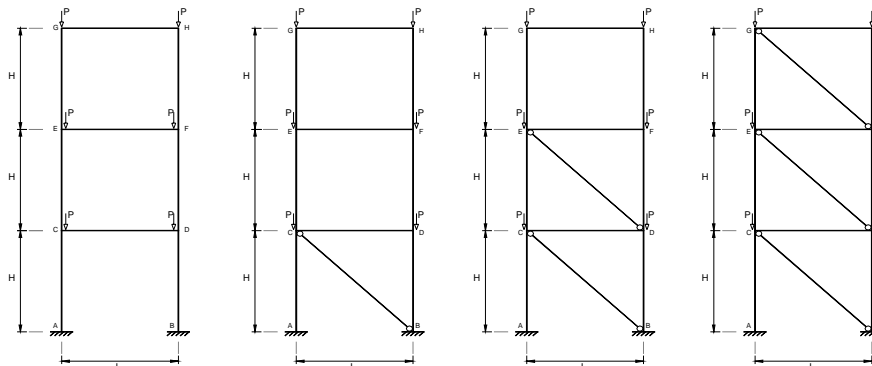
Pórtico plano de 3 pisos, sem contraventamento e com contraventamento múltiplo
